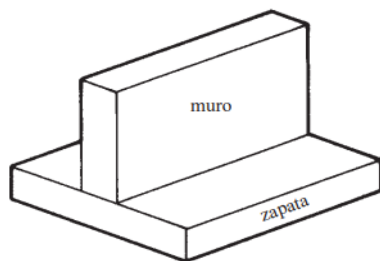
Zapata corrida para muro (McCormac, J., 2011).
